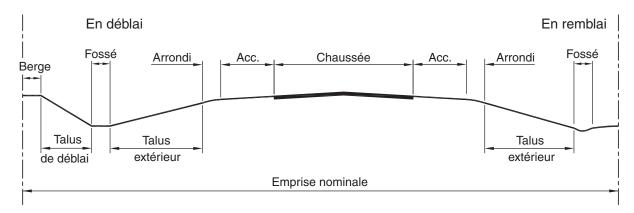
Éléments d'une route à chaussée unique, coupe transversale
